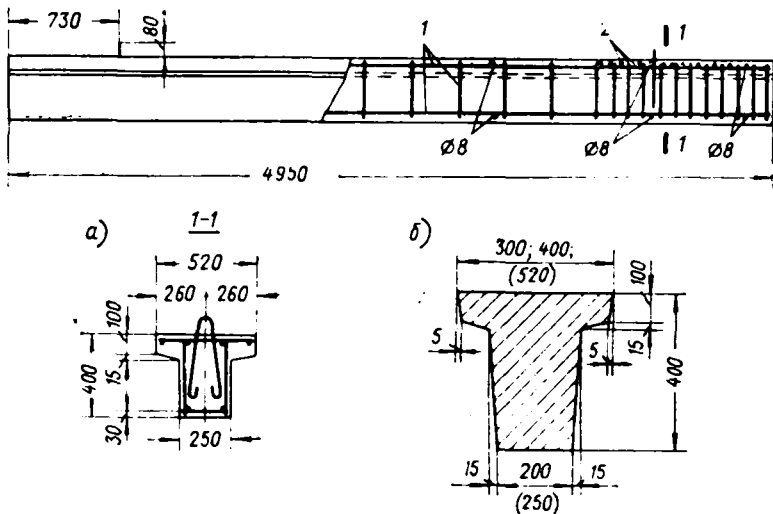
Фундаментные балки для колонн с шагом 6 м
